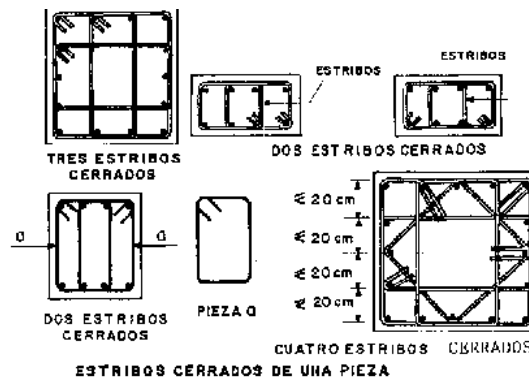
Tipos de estribos de confinamiento presentes en pórticos de concreto armado.
